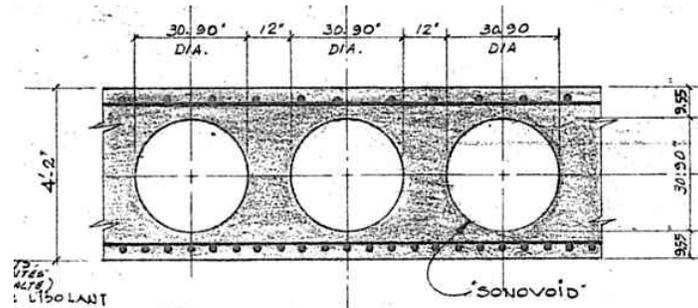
Zone évidée de la voûte du tunnel, Coupe 1-1 de la Figure 4 (source : STM 1964, Station Champ-de-Mars coupes des accès, No. 208)
